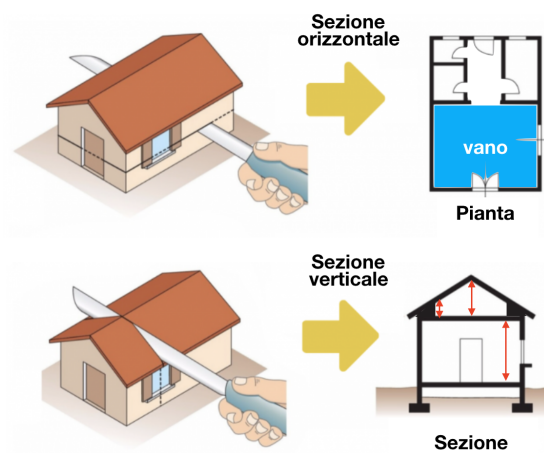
Esempio di semplice edificio con pianta rettangolare per ogni piano. In alto, è mostrata la pianta del primo piano, nella quale è stato evidenziato un vano in celeste. In basso, è mostrata la sezione verticale in cui sono evidenziate in rosso varie altezze dei vani.
